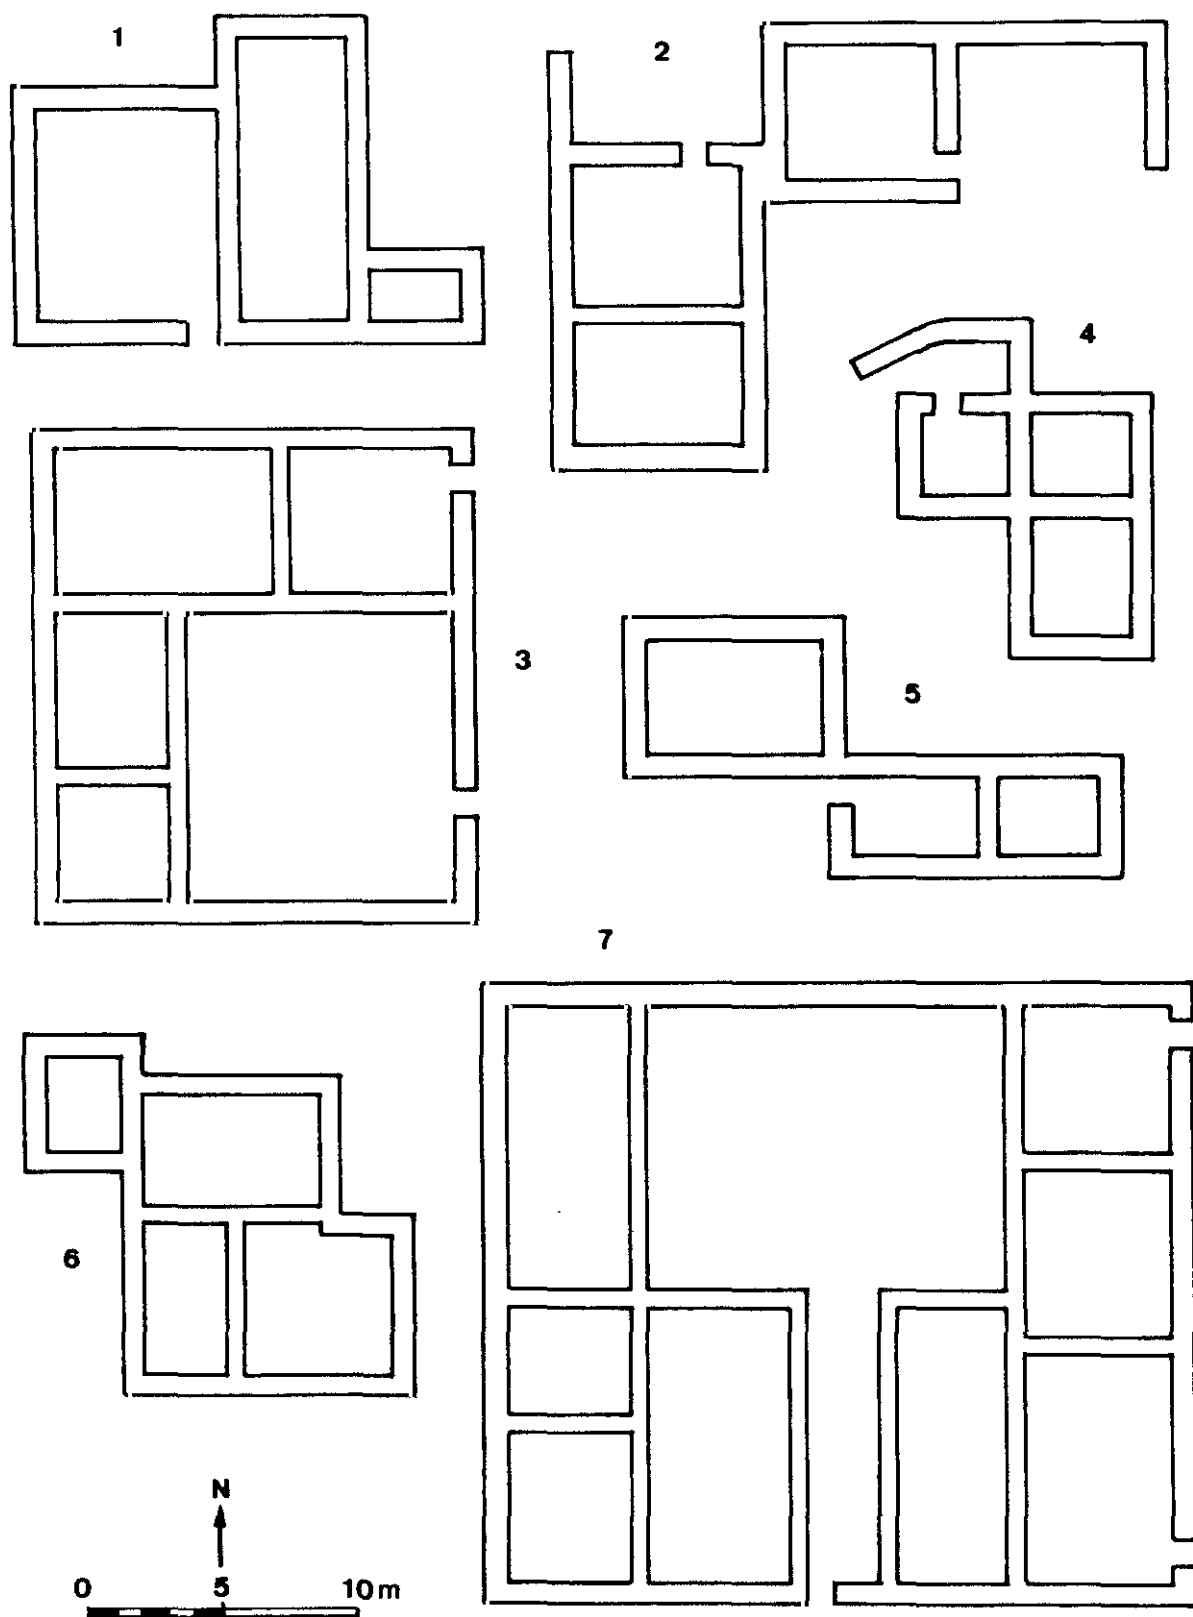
Croquis de plantas de estructura compleja del castro de Ulaca, Solosancho (Avila).
